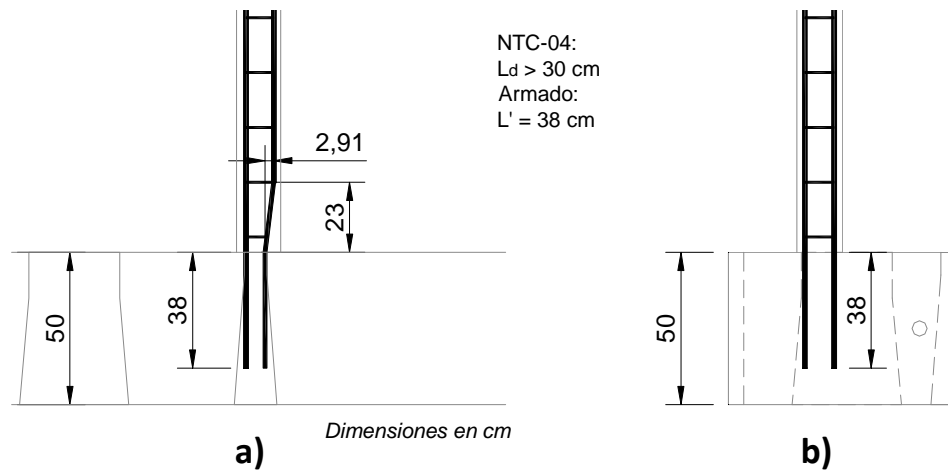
Anclaje en viga de cimentación a) en forma de bayoneta, b) sin modificar
